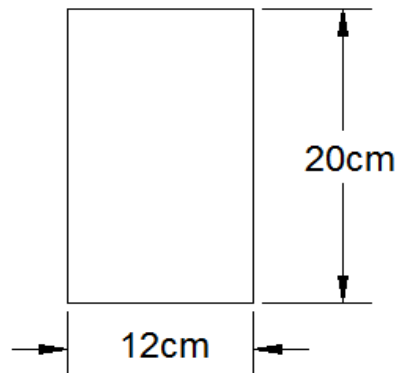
Coupe schématique de la poutrelle (appuis).
